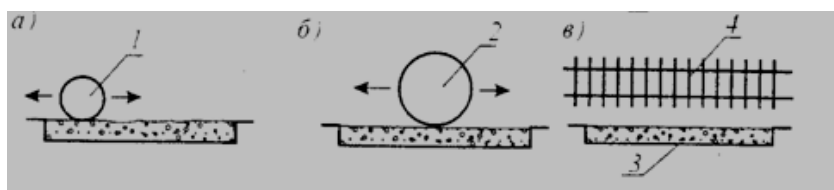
Уплотнение бетонной смеси при формировании плит
